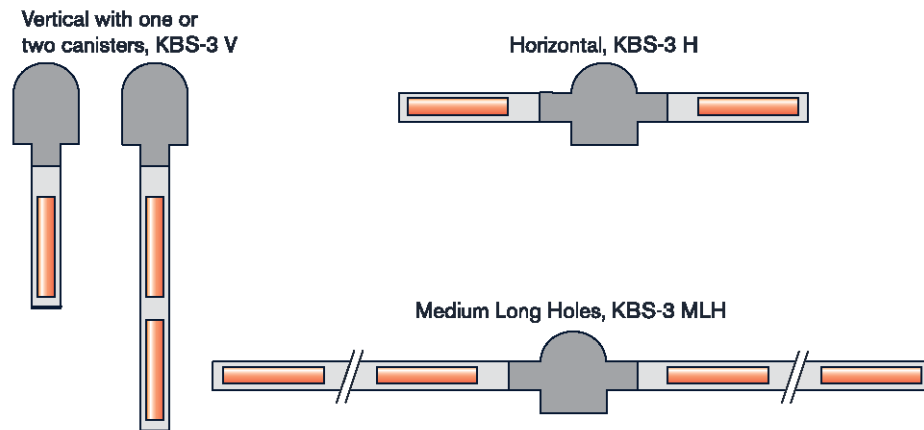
Einlagerungsvarianten für ausgediente Brennelemente – Schweden /2-9/
